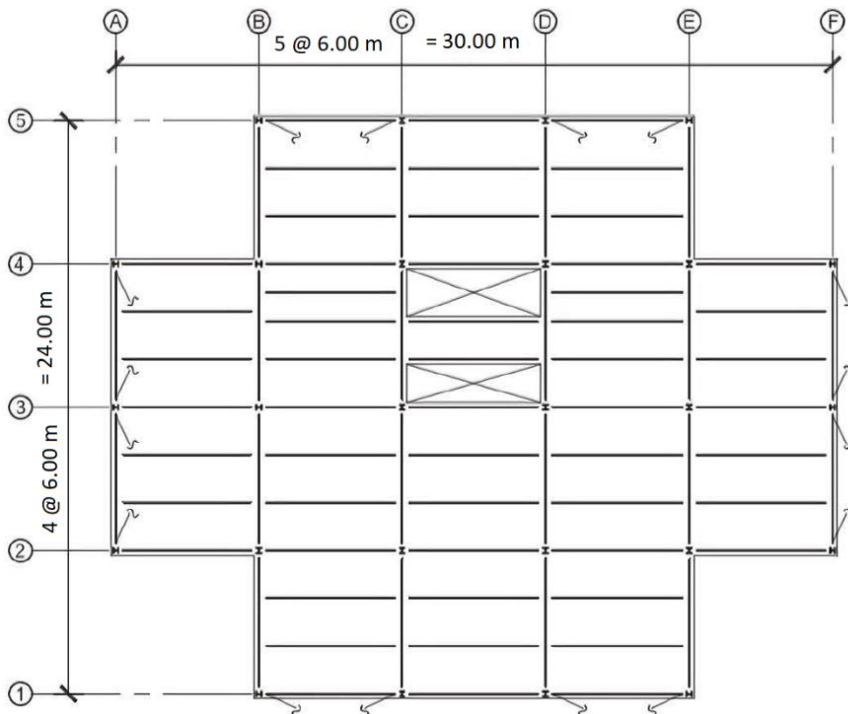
Distribución en planta de Pórticos del Sistema PRM
